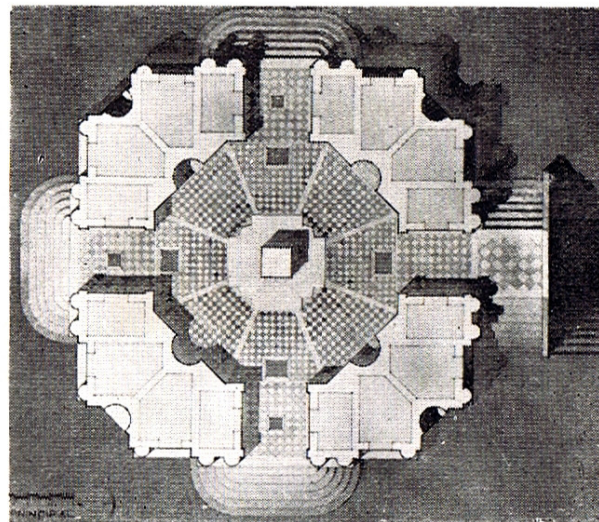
Rotonda del Cementerio Central — Planta principal.
